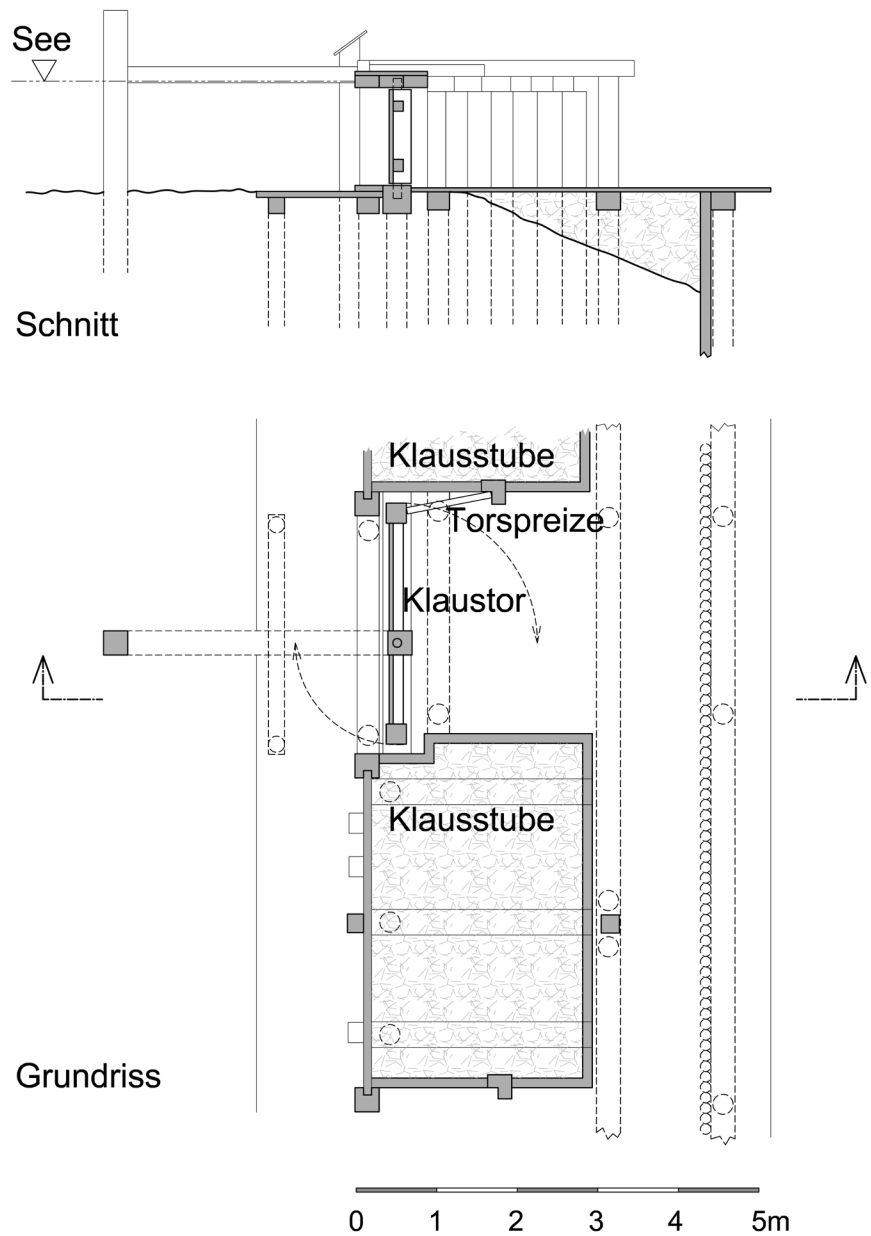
Grundriss und Schnitt eines Klaustores.
